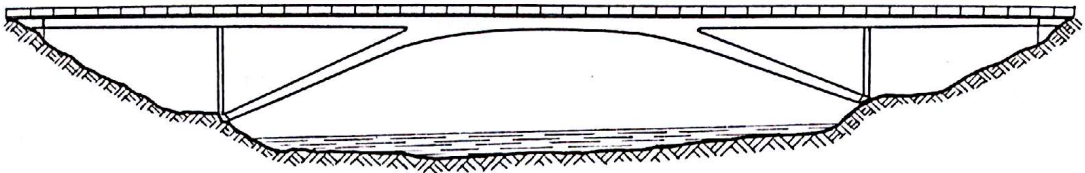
PÓRTICO COM PILARES INCLINADOS
